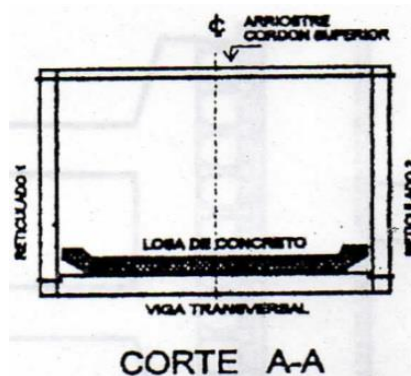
Puente Reticulado. Fuente: Puentes: Análisis, Diseño y Construcción (López), 1994.
